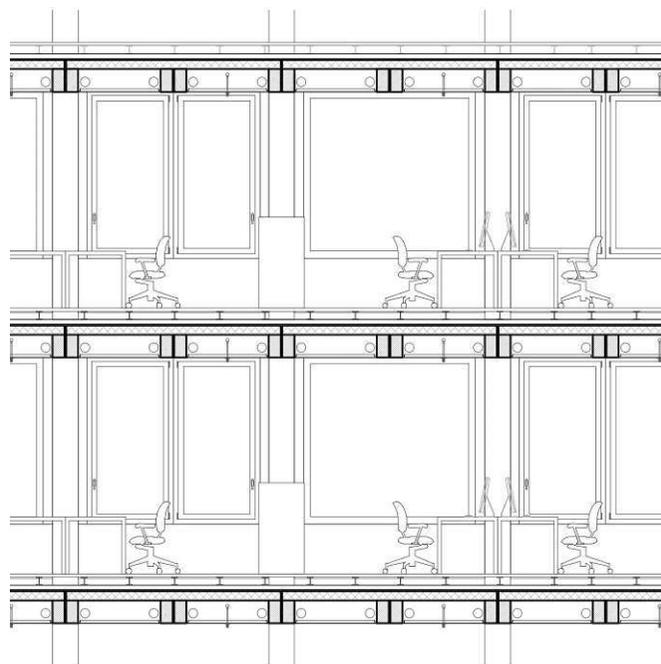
Schnitt durch die Decken mit Sprinkleranlage
